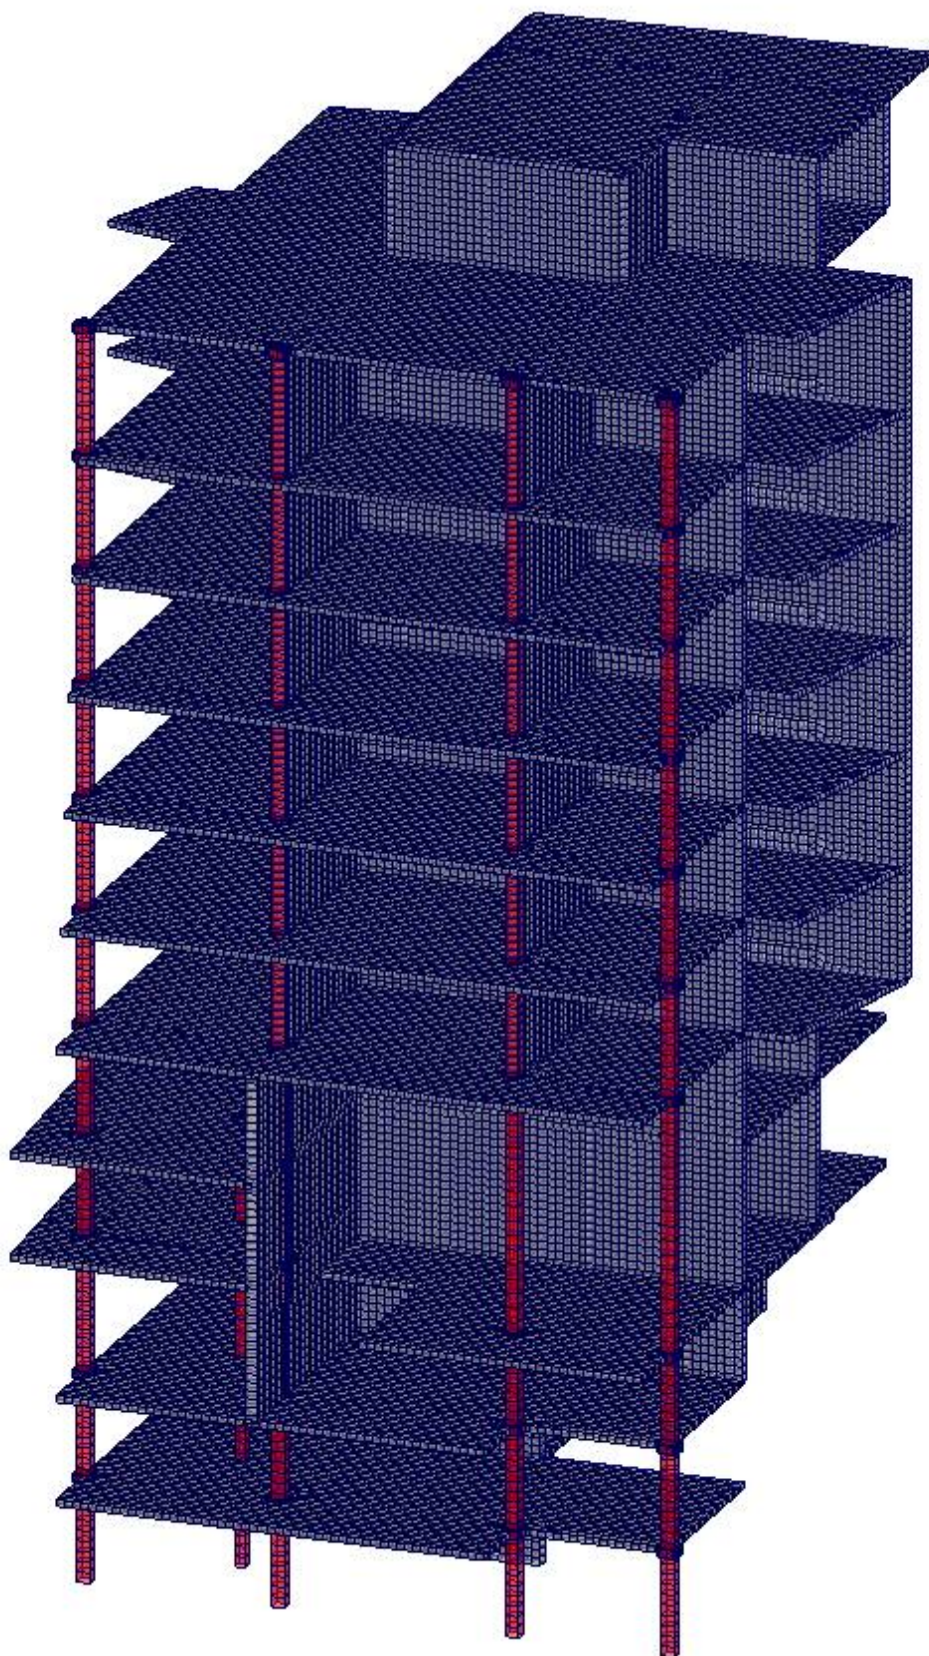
Общий вид расчетной схемы жилой части здания
